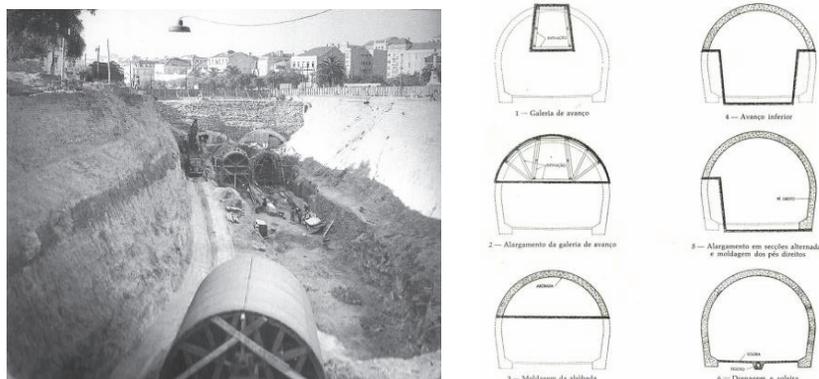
Execução, a céu aberto, na zona da rotunda do Marquês de Pombal e fases de construção do túnel no trecho Rotunda-São Sebastião do ML (Revista Técnica 265, outubro de 1956).
